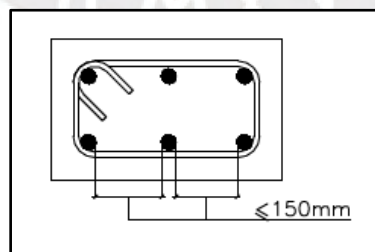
Espaciamiento máximo de acero longitudinal sin tener que colocar estribos en columnas
